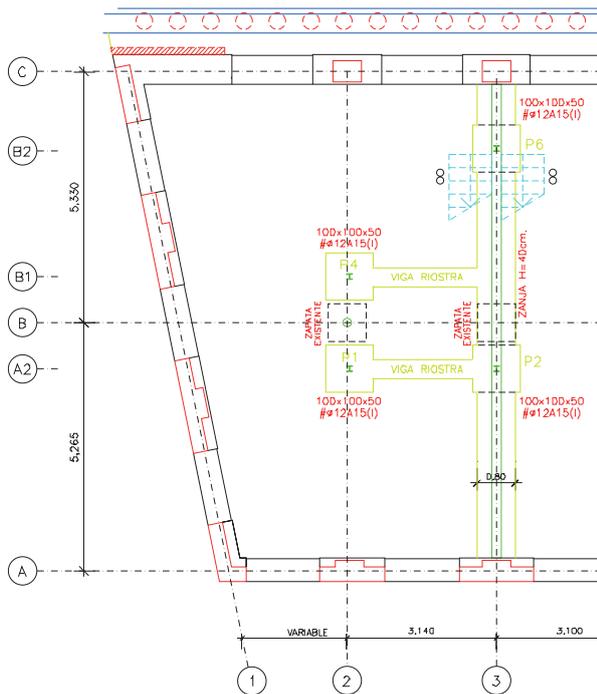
Planta d'estructura definitiva. | Planta de estructura definitiva.
